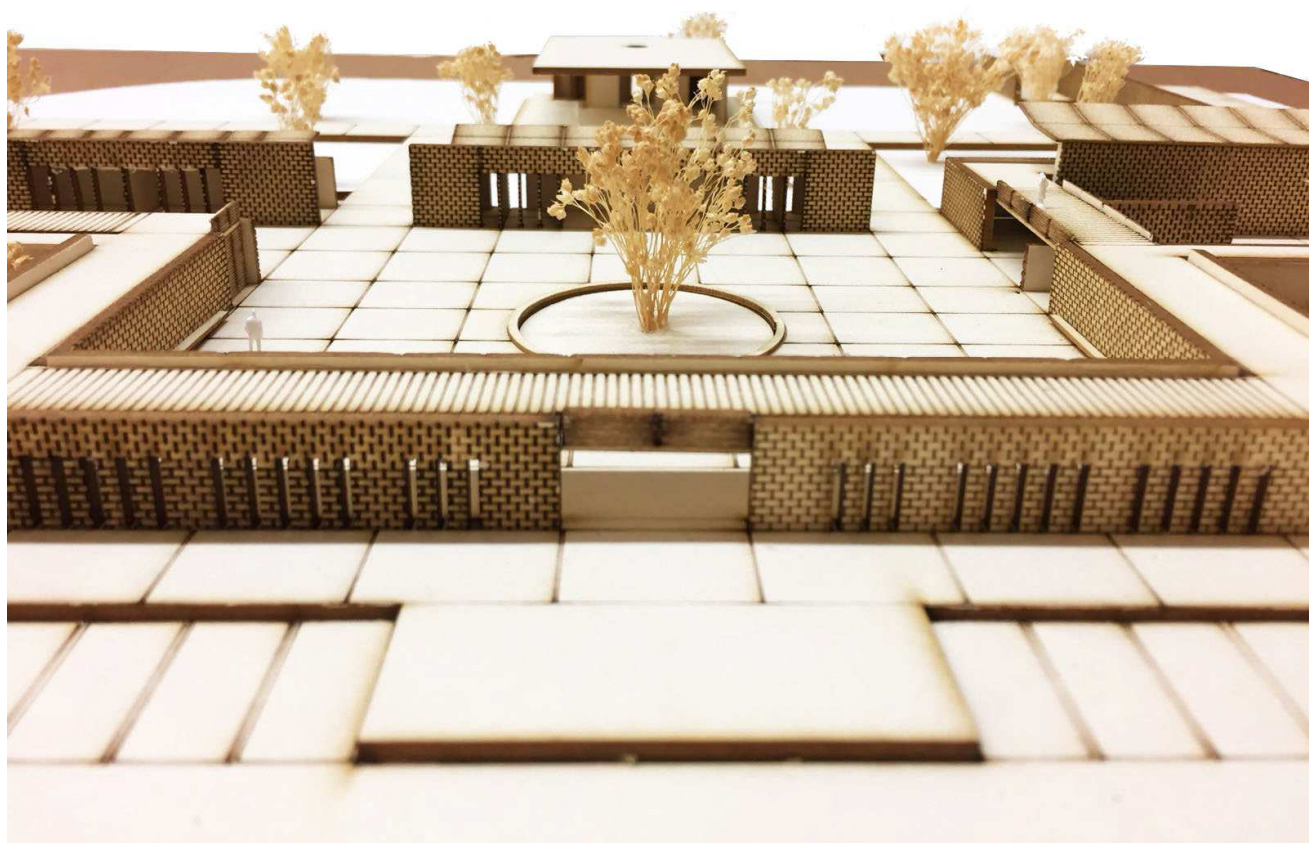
MAQUETE- PRAÇA CENTRAL - IMAGEM: AUTOR
